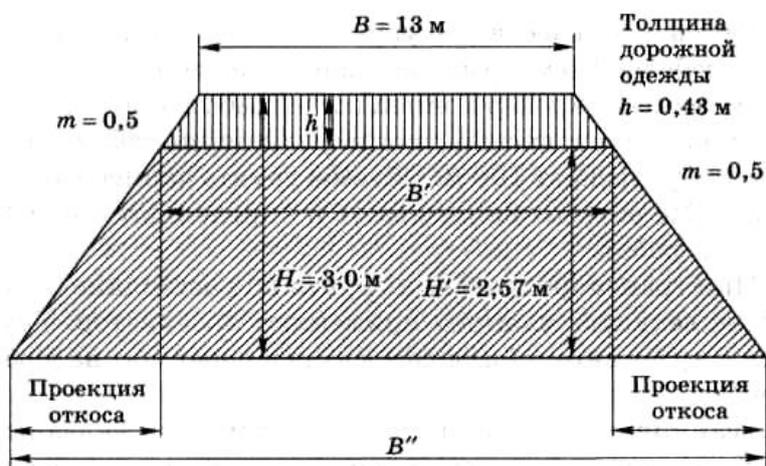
Расчетная схема подошвы дорожного полотна
